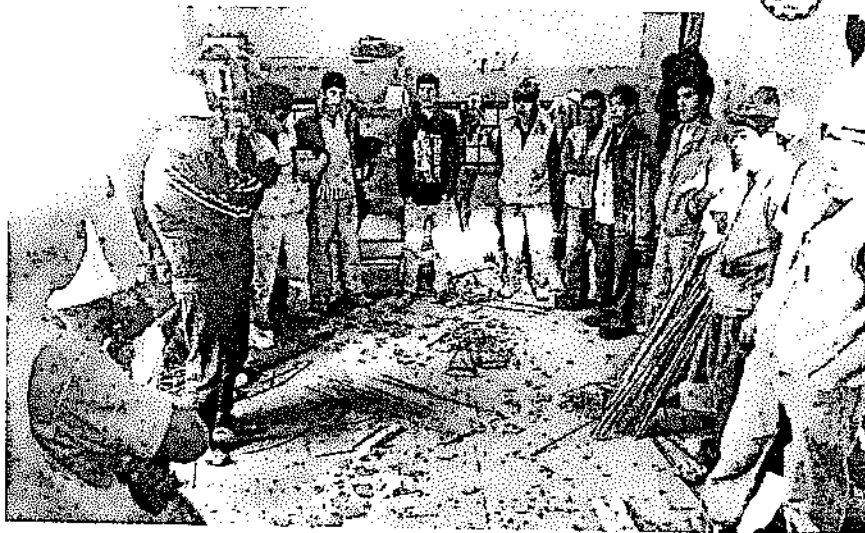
Obra RECONSTRUCCIÓN DELA INSTITUCION EDUCATIVA
